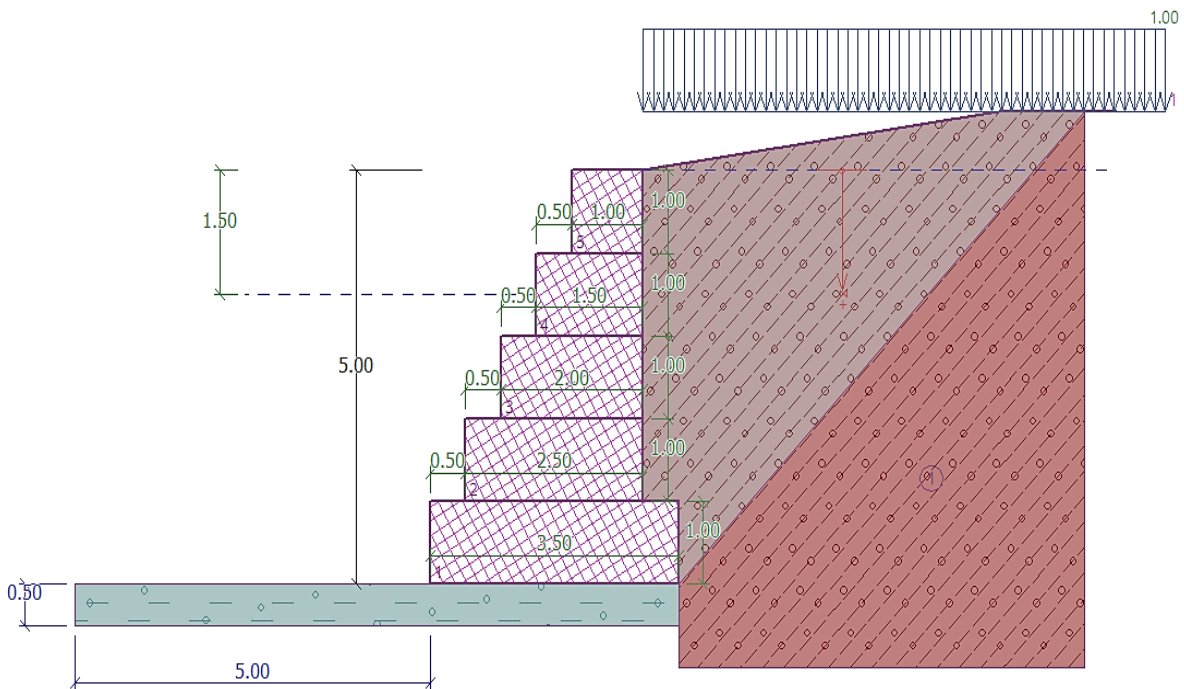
Vista 2D de la estructura propuesta (gavión y colchón anticavante).
